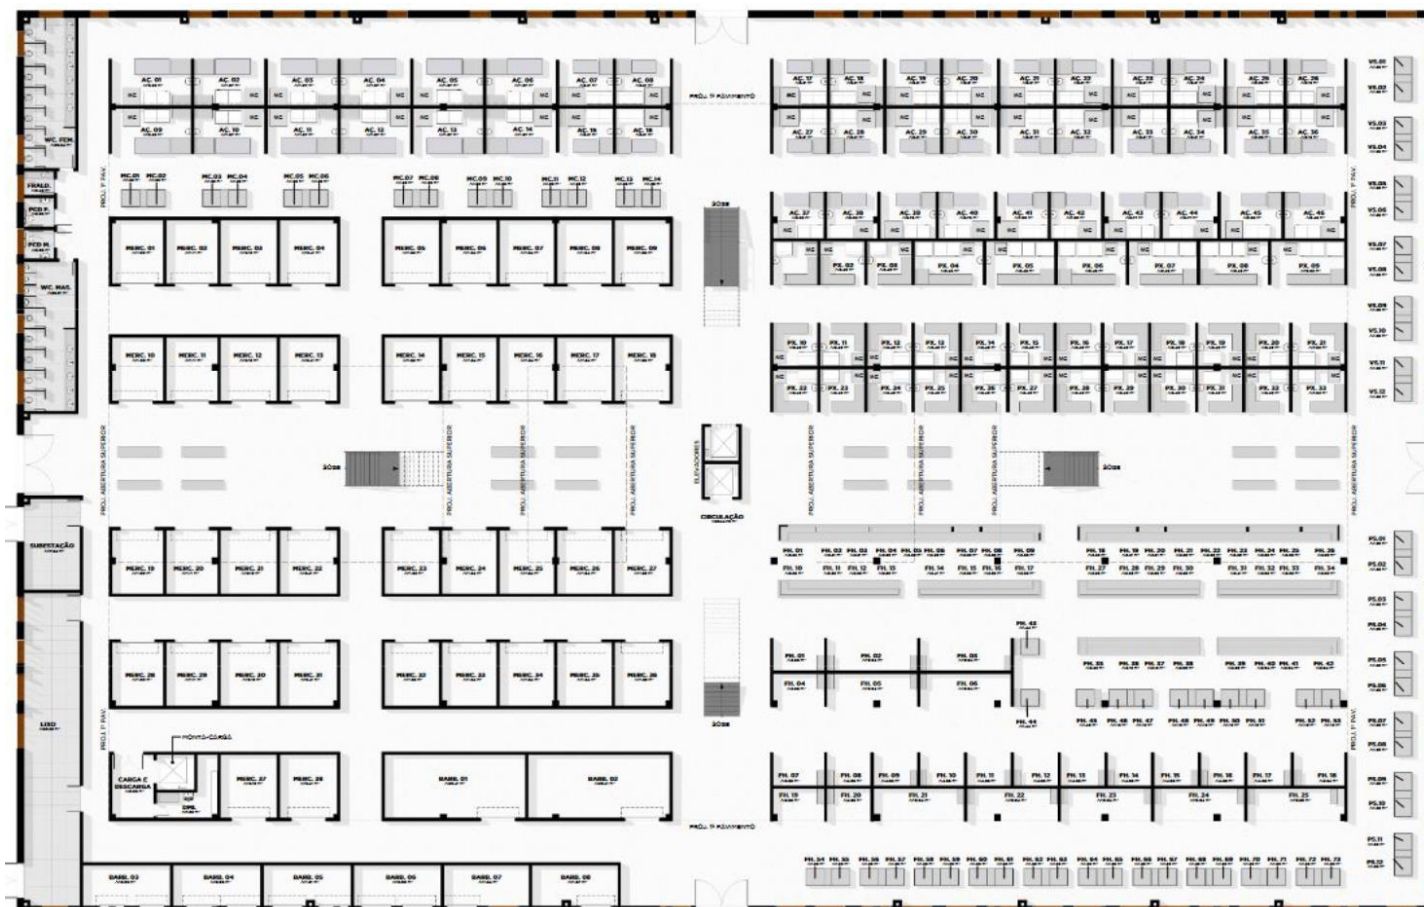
Projeto de Requalificação do Mercado Central: planta baixa primeiro pavimento (boxes/lojas para venda de artesanato e setor administrativo)
